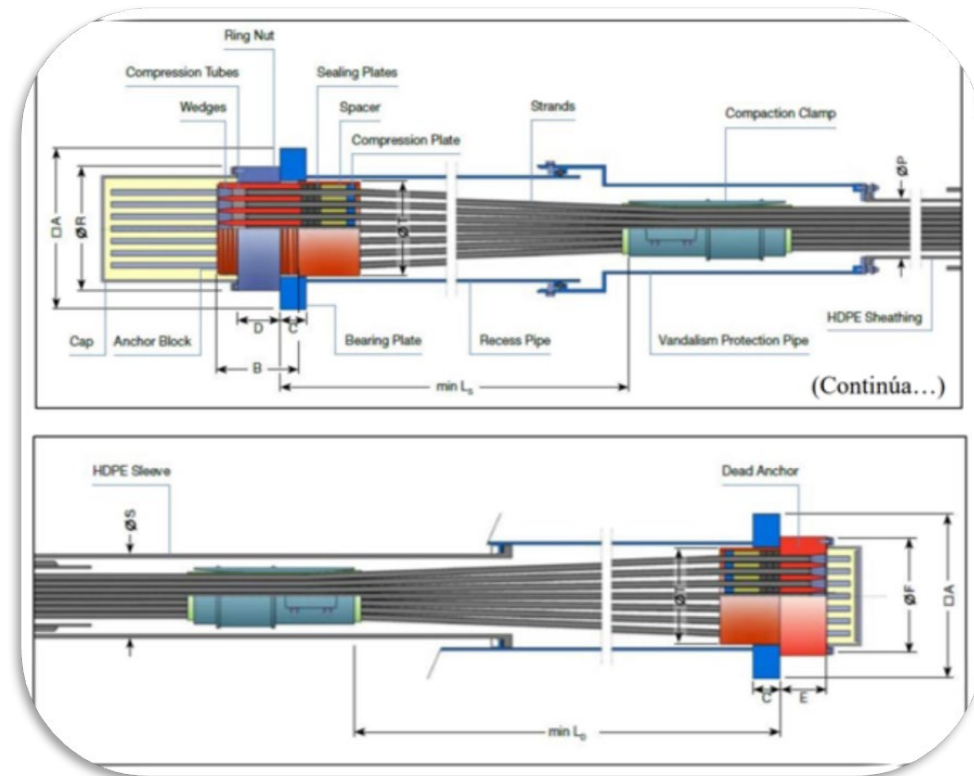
Extremo cilíndrico de cables, marca DSI. Fuente: [32]
